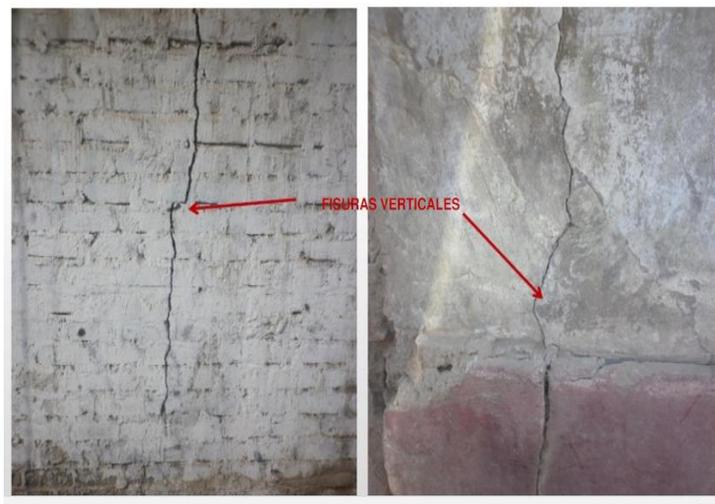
Fisuras en albañilería. (León de los R.)
